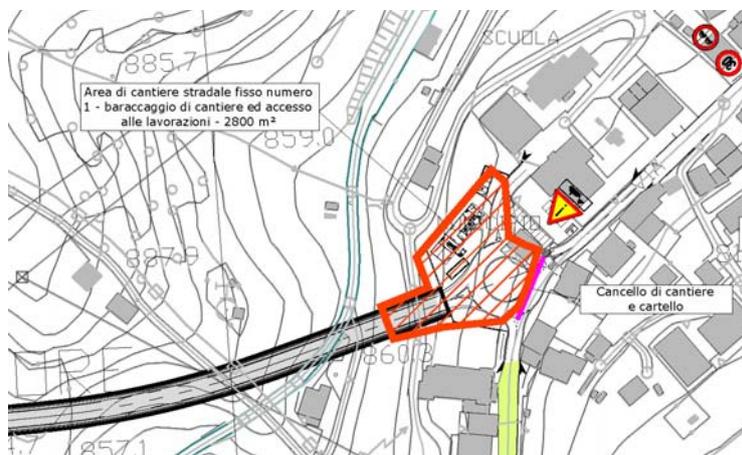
Direzione dei flussi di traffico ed area di cantiere stradale fisso numero 1
